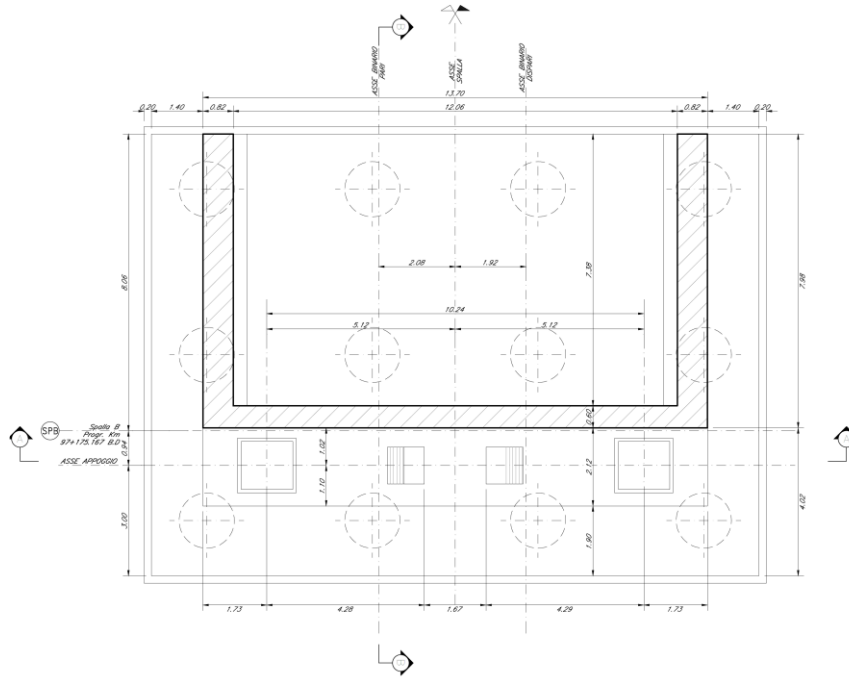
Vista in pianta della spalla B – Lato Ventimiglia
